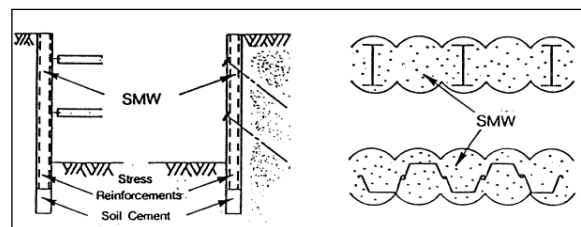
Planta y corte de un soporte de excavación realizado con la técnica de soil-mixing.
